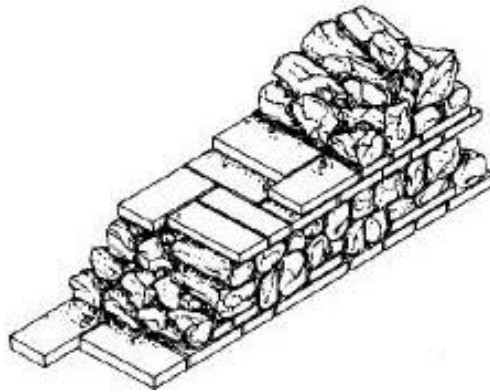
Sezione muraria con abbondante presenza di elementi di collegamento (diatoni) tra i due paramenti.
